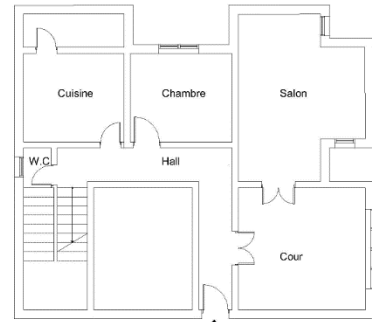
plan initial d'un logement F4. Niveau inférieur
